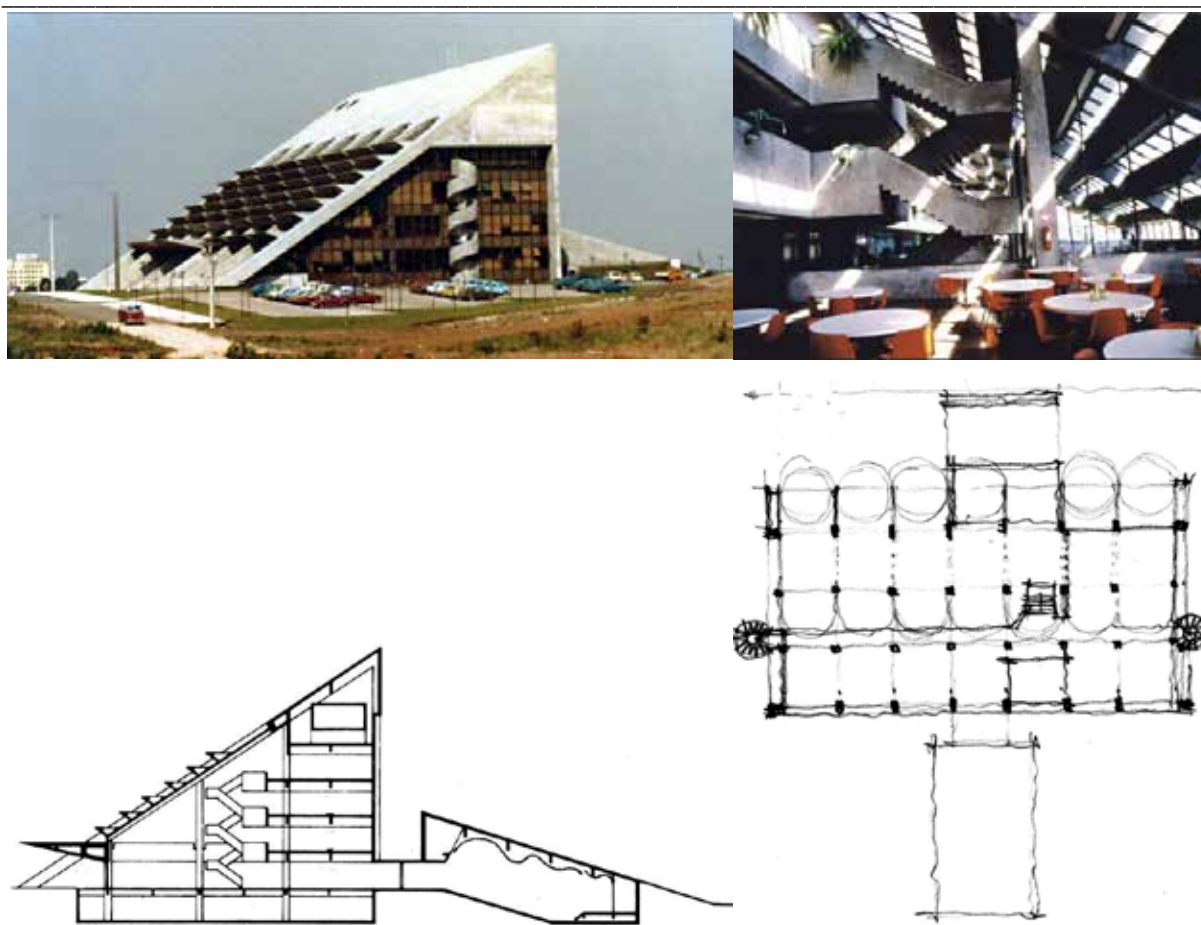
vista externa do edifício. Destaque para o brise situado na face inclinada (norte), composto por vigas floreiras.
